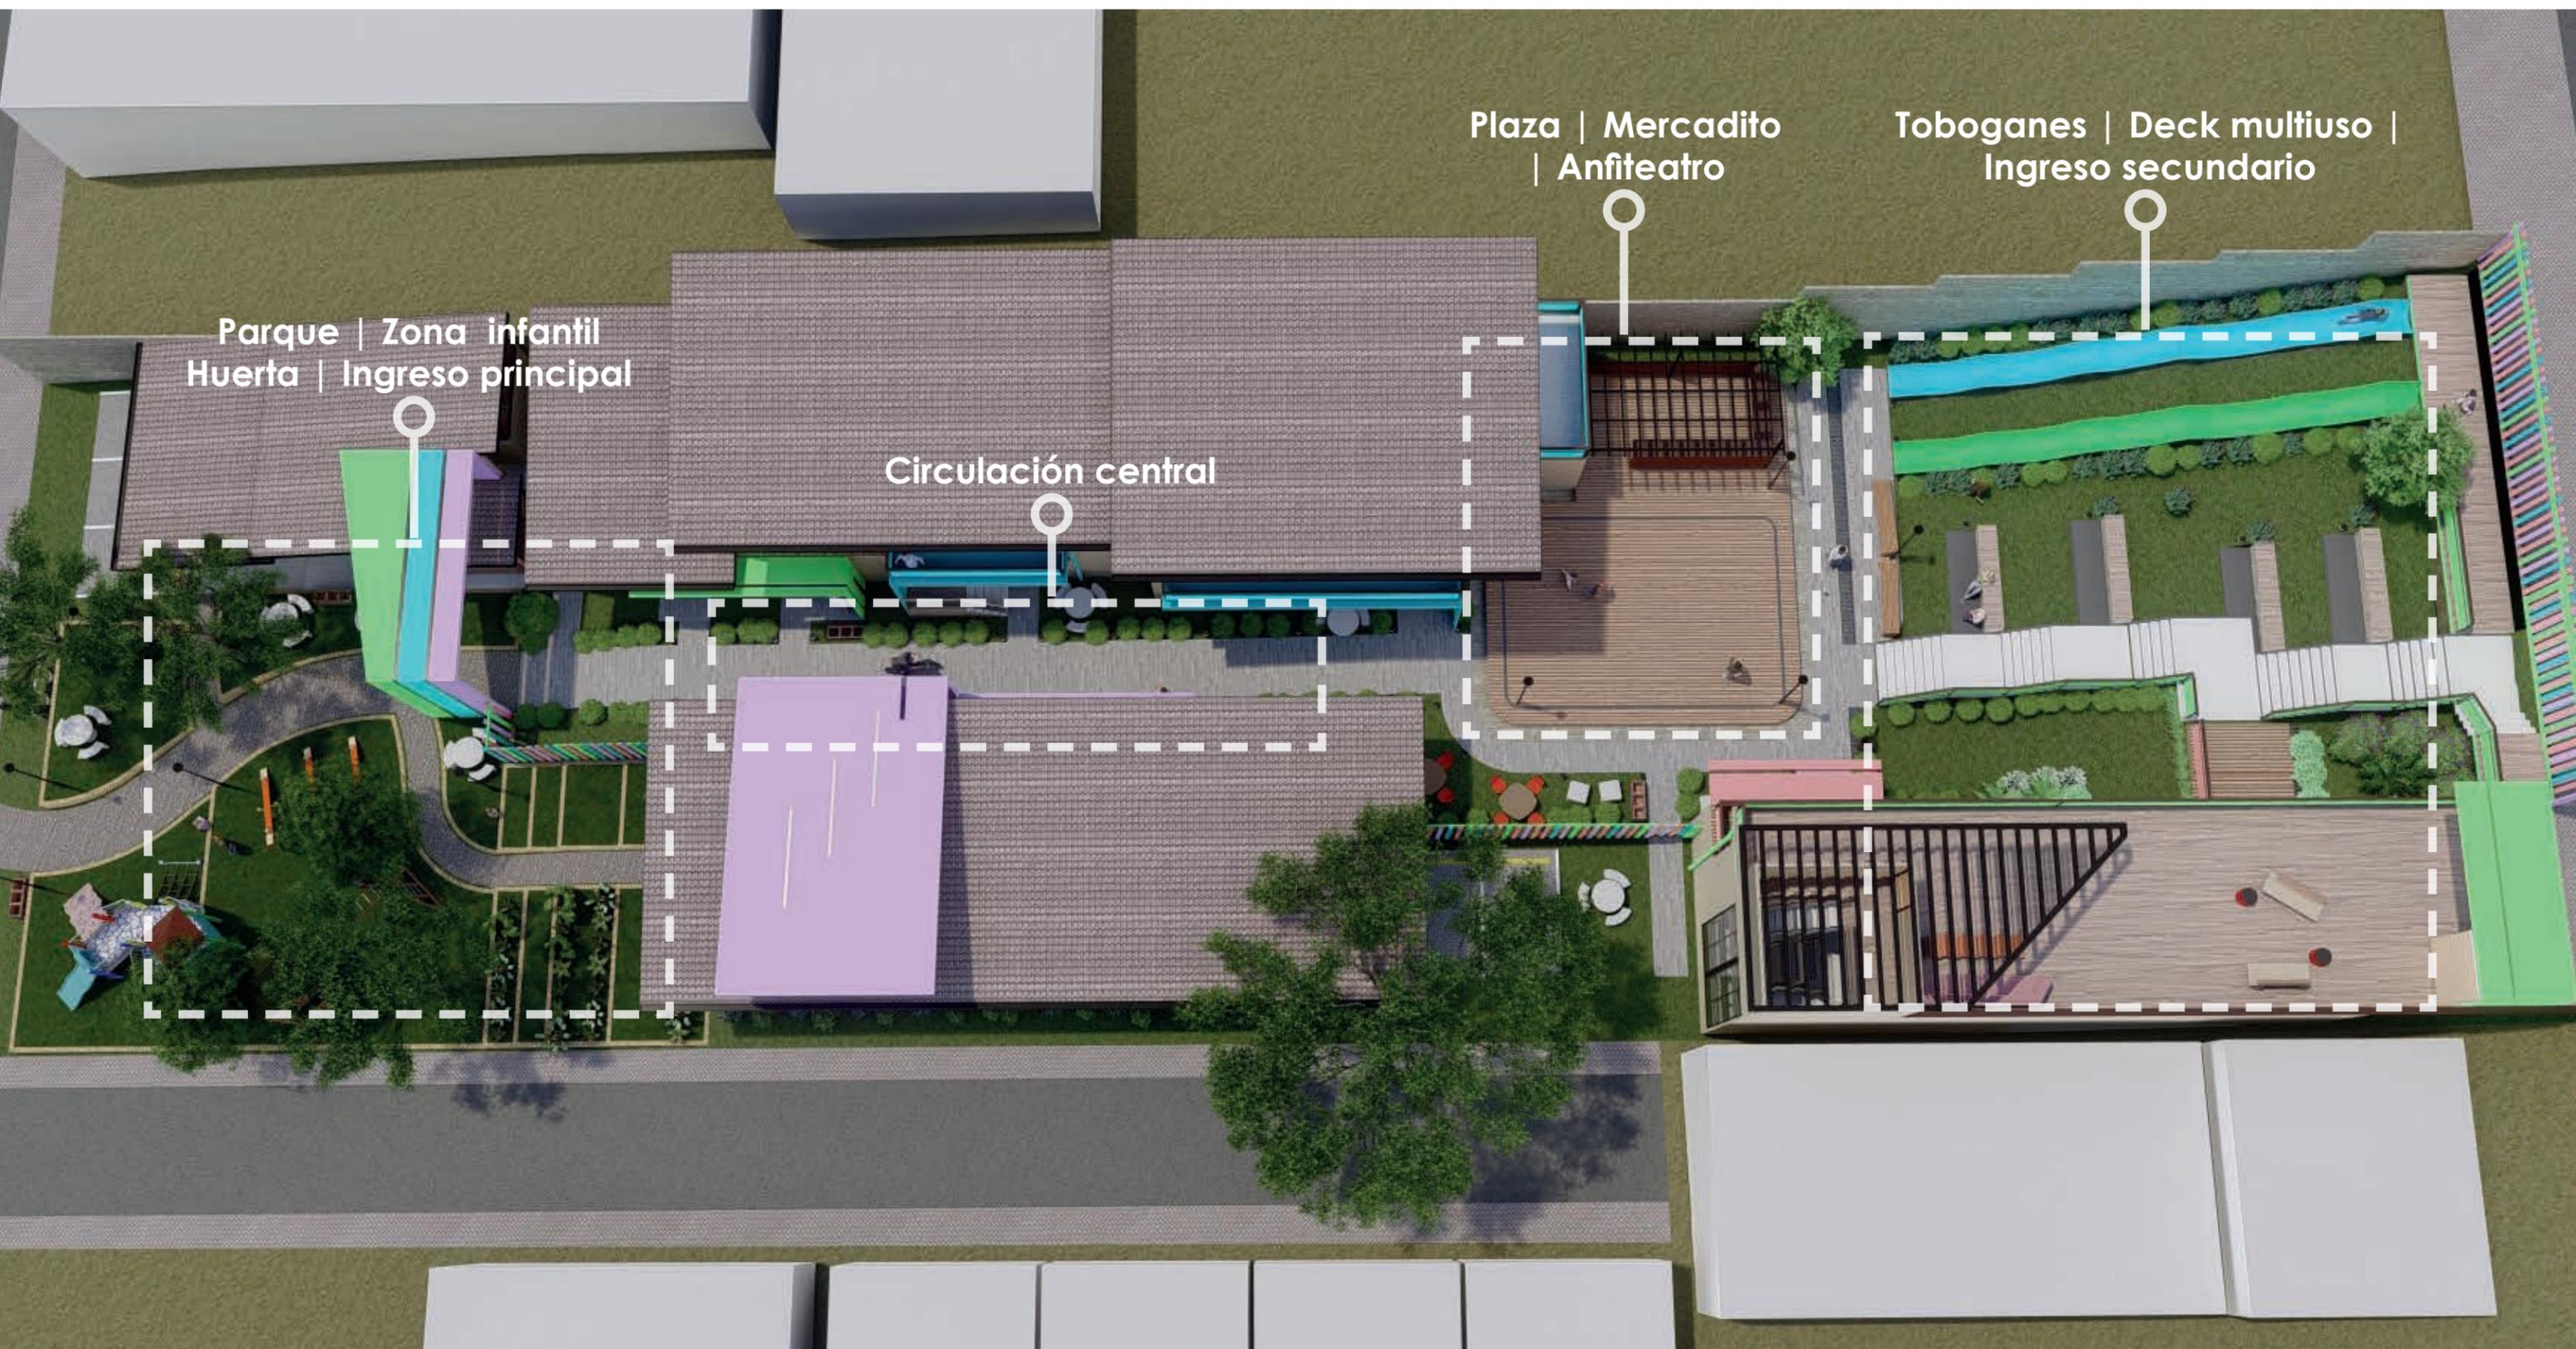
Planta espacios externos. Fuente: Propia.
